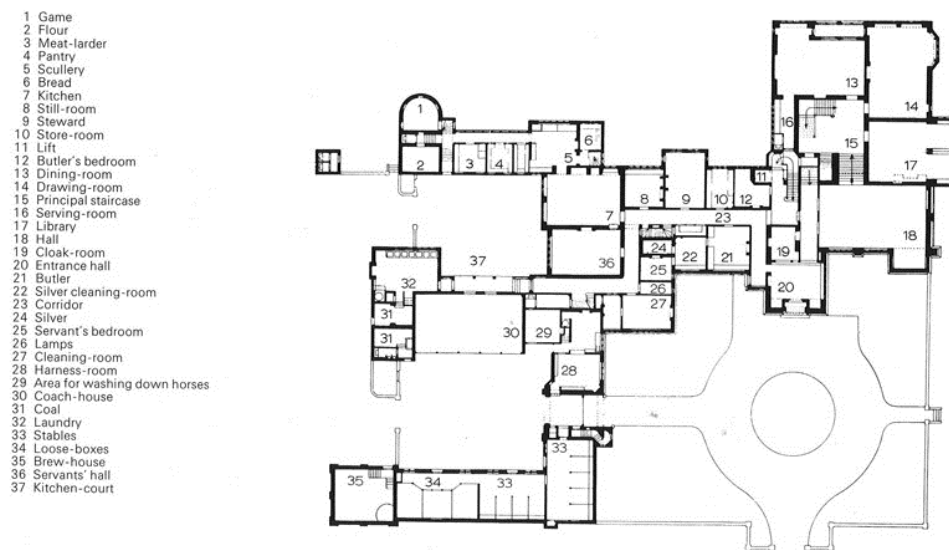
Grundriss in einer englischen Villa – Cloverly Hall
